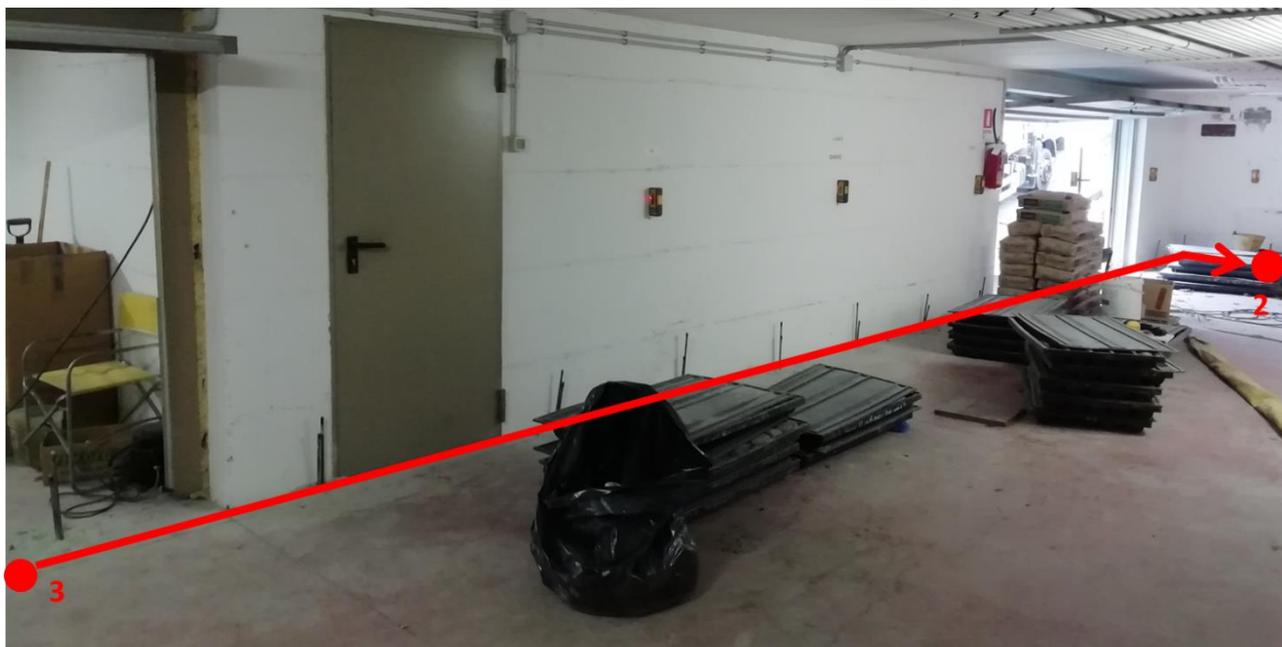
Facciata interna con profilo iniezioni 3-2
